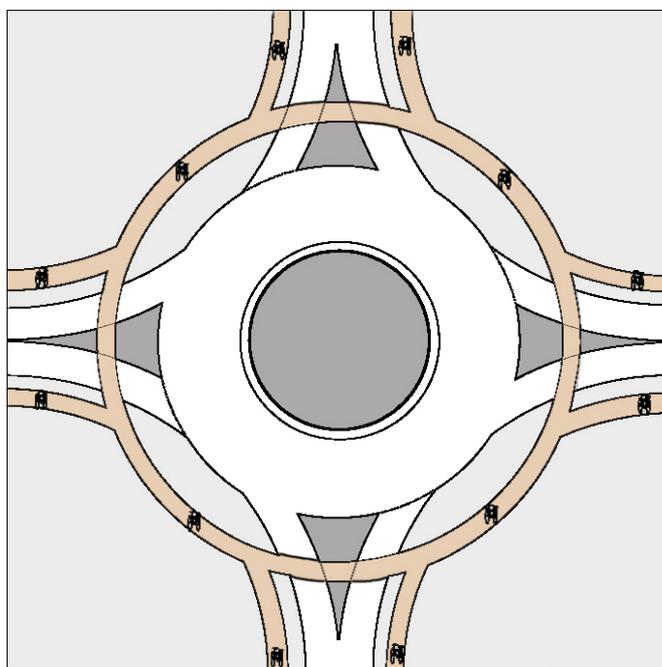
Schema di rotonda con pista ciclabile esterna e separata dall'anello veicolare, proposta dalle Norme sulle caratteristiche funzionali e geometriche delle intersezioni stradali
